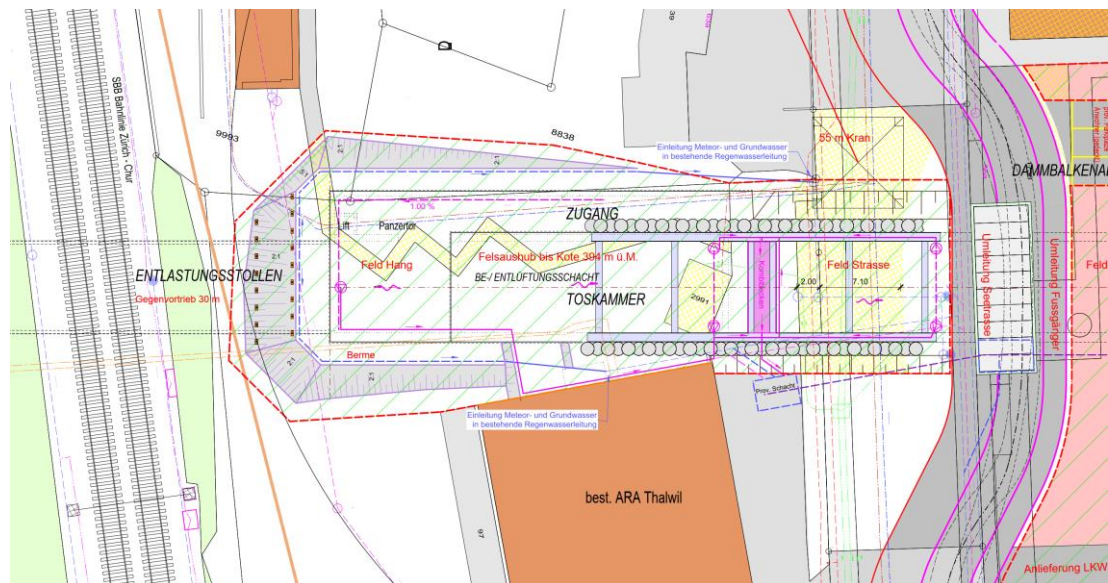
Bauphase 3: Arbeiten in den Feldern Hang und Strasse (Auszug aus Plan 33-310)
